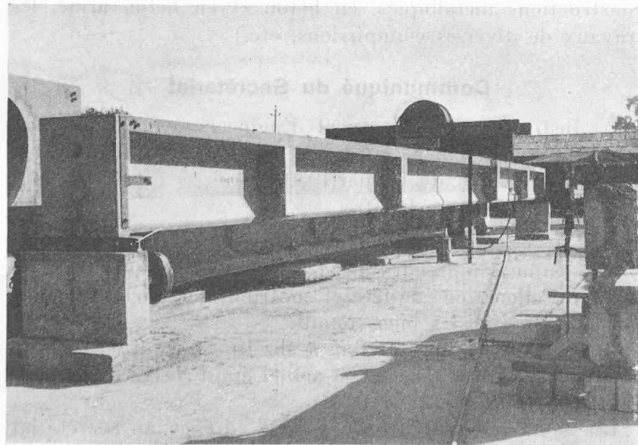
Essai d'une poutre des tabliers du pont de Darguinah.
